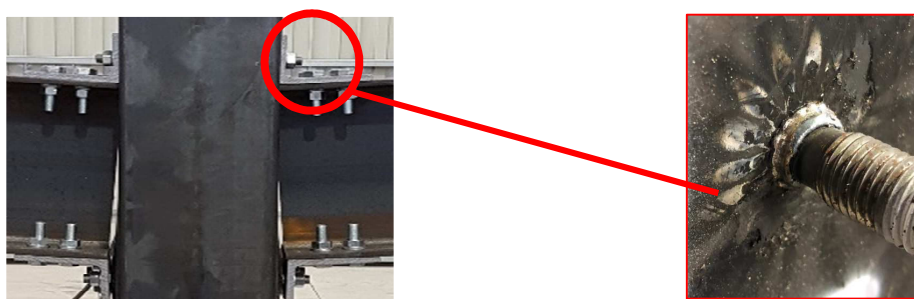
Unión viga-columnas y detalle de perno soldado.
